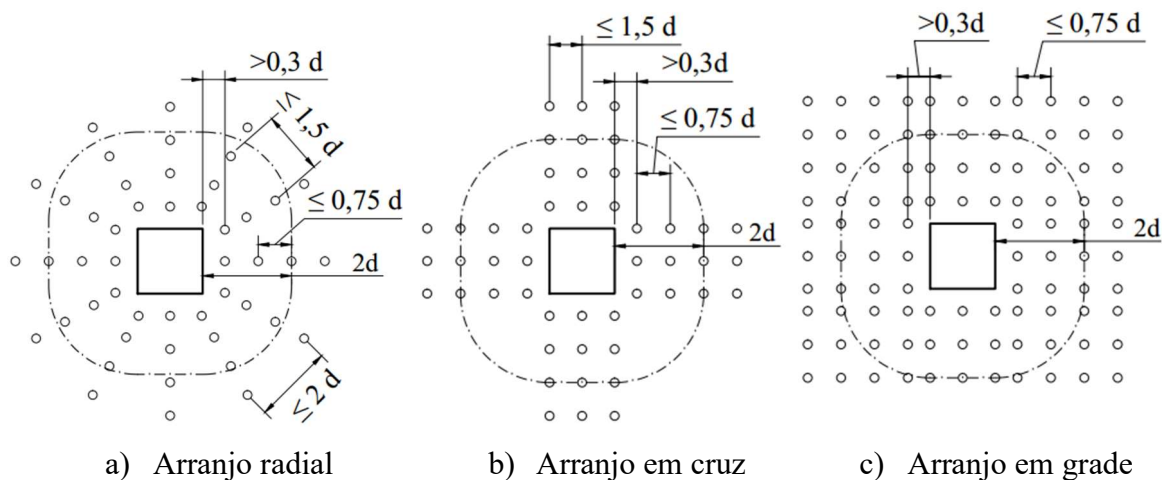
Especificações para posicionamento em planta da armadura de cisalhamento segundo o Eurocode 2
